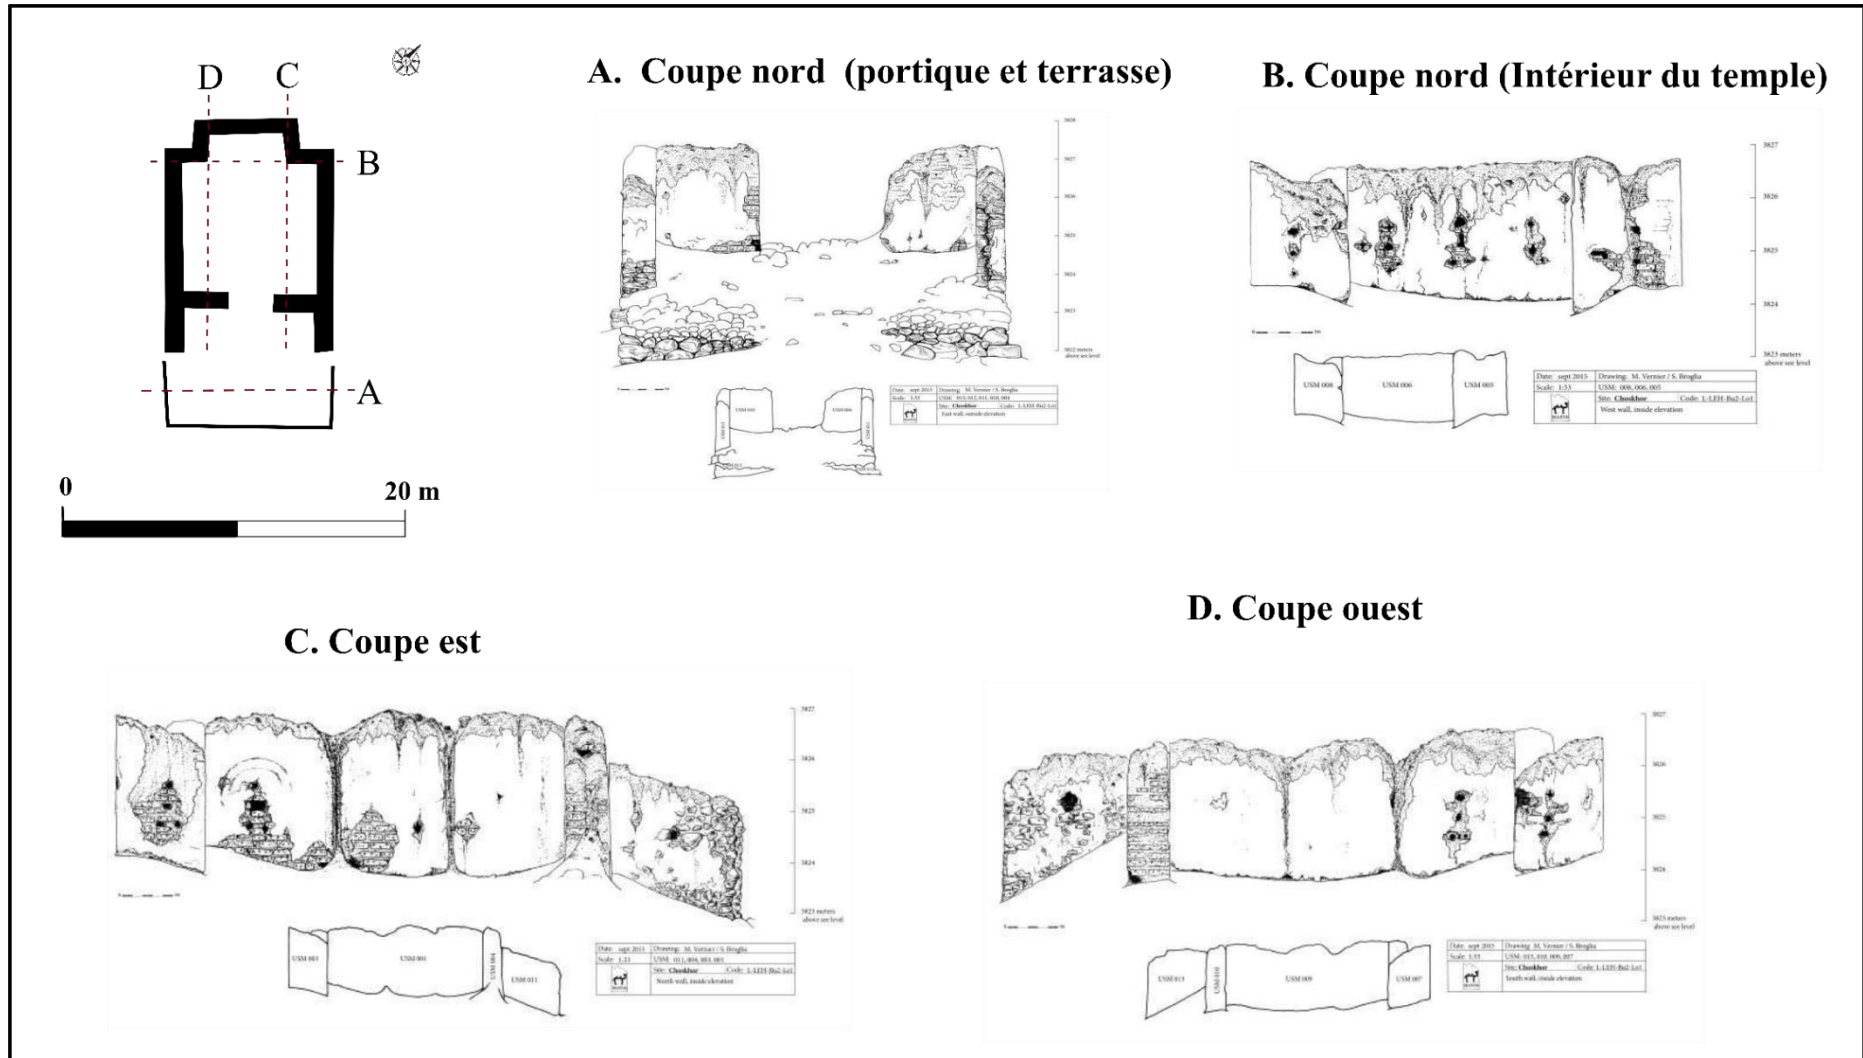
Plan et section du temple 1 de Leh Choskhor (Source : MAFIL)
